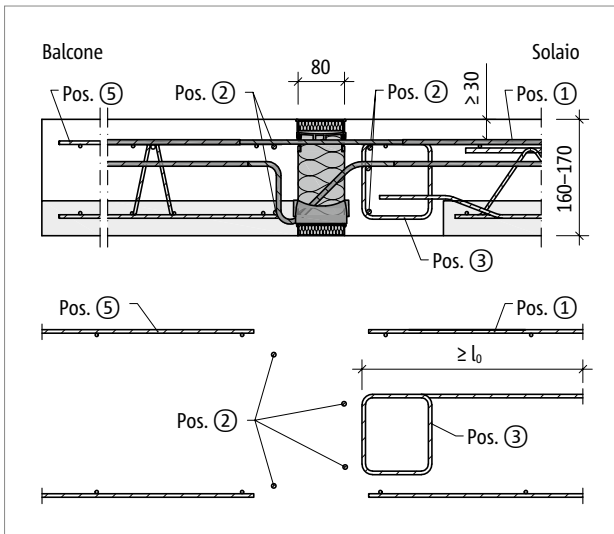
Schöck Isokorb® T tipo K-F: armatura in opera con spessore soletta del balcone $h = 160-170$ mm
